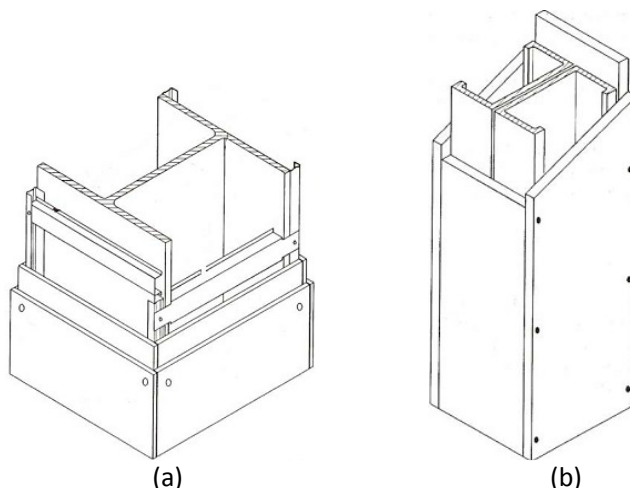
Pilar interno, (a) enclausuramento com suporte, (b) enclausuramento sem suporte
